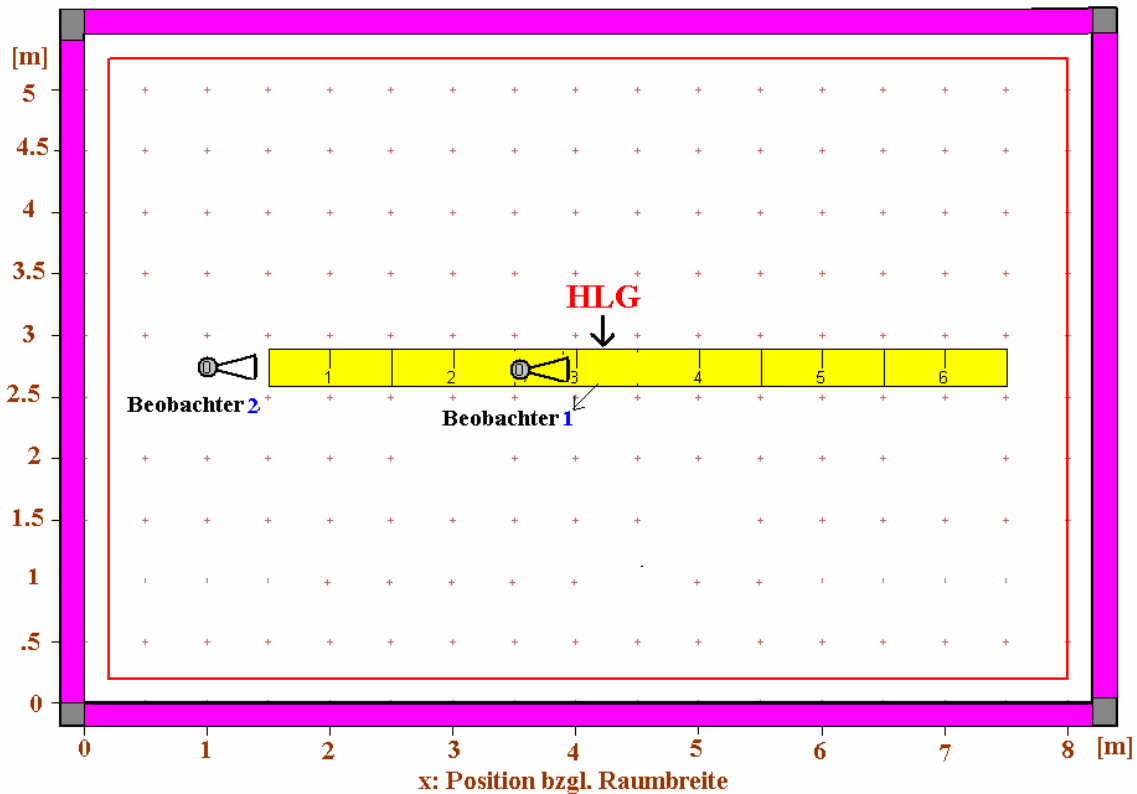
Grundriss des Spezialversuchsraums mit den Beobachterplätze
